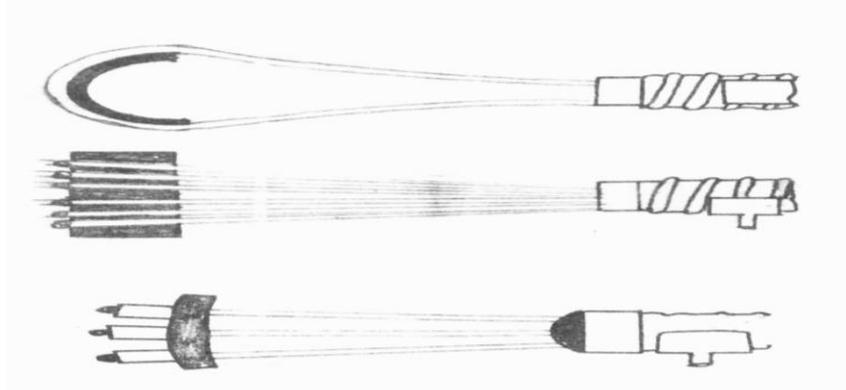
Detalles de tipos de anclajes Pasivos
